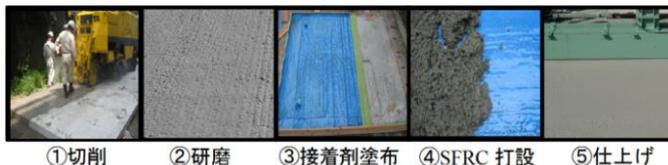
SFRC 上面増厚補強 RC 床版の施工手順
